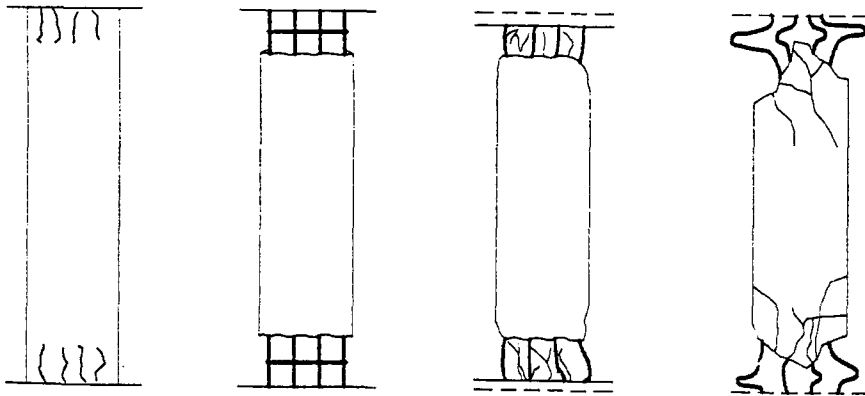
Kolon üst başında ileri derecede kesme kırılması (Bayülke, 1997).
